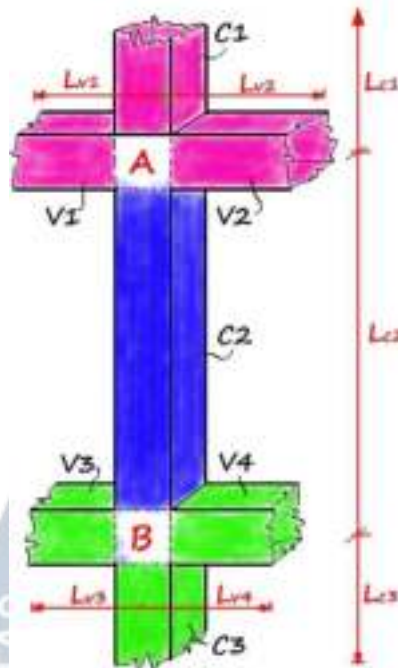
Ubicación de vigas y columnas para obtener ψ_A y ψ_B
